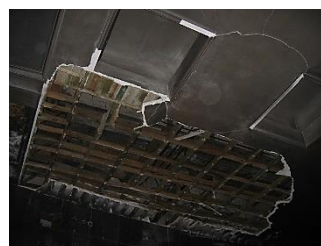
Pormenor da degradação do tecto na área correspondente ao balcão.
